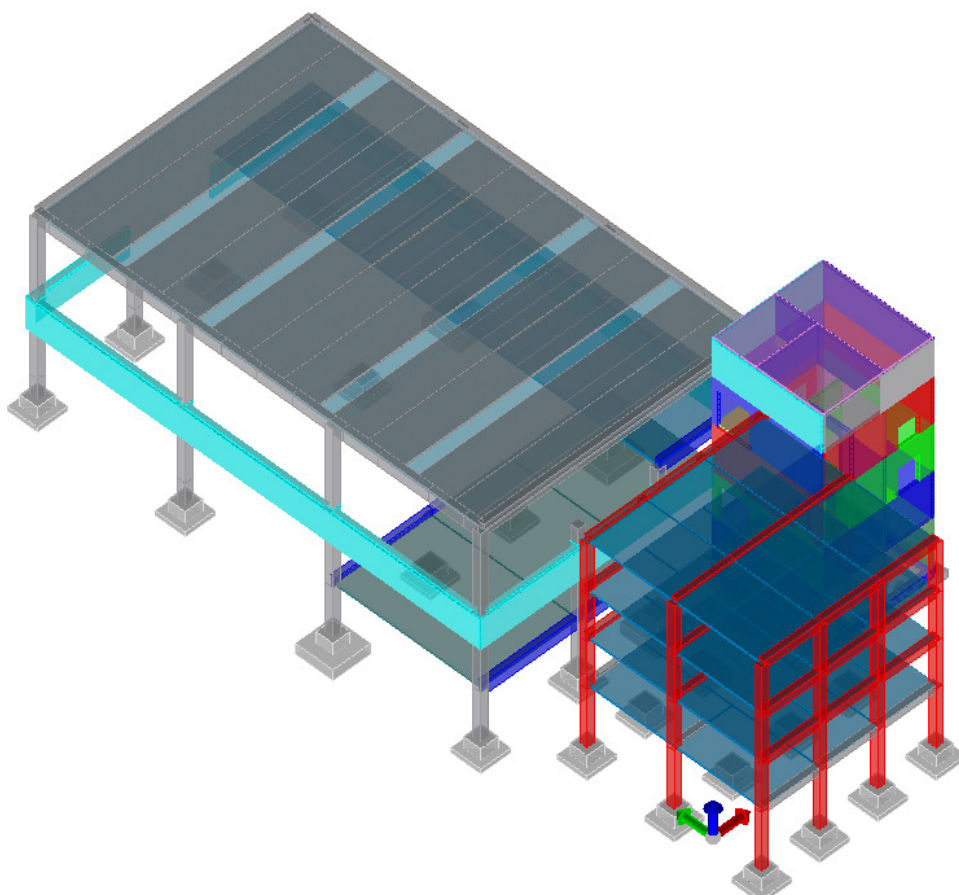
Vista degli elementi strutturali, prospetto NORD-OVEST - Modello FEM
